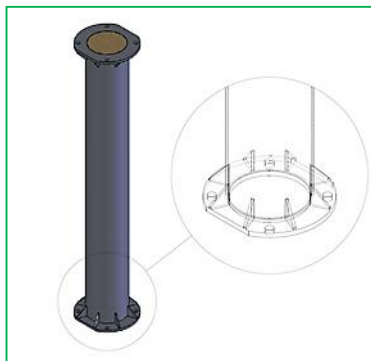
poutre mixte circulaire. Goulet, 2008
